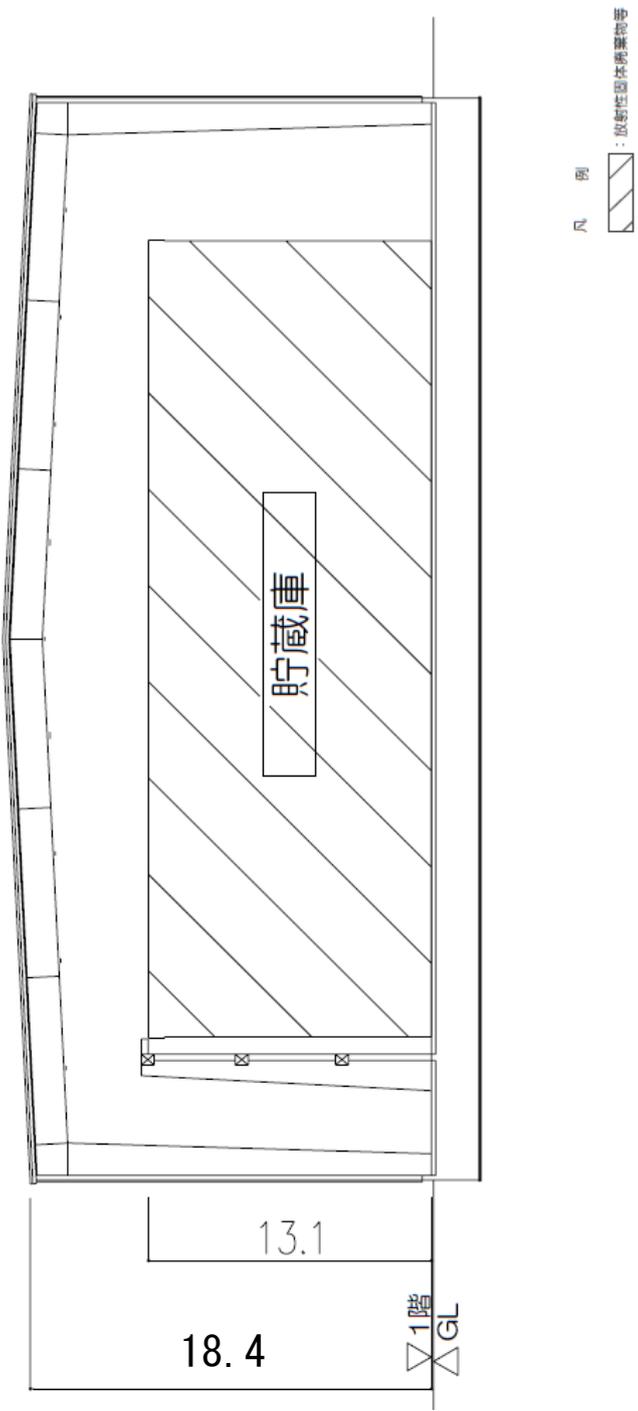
固体廃棄物貯蔵庫第10棟 断面図 (単位: m)
